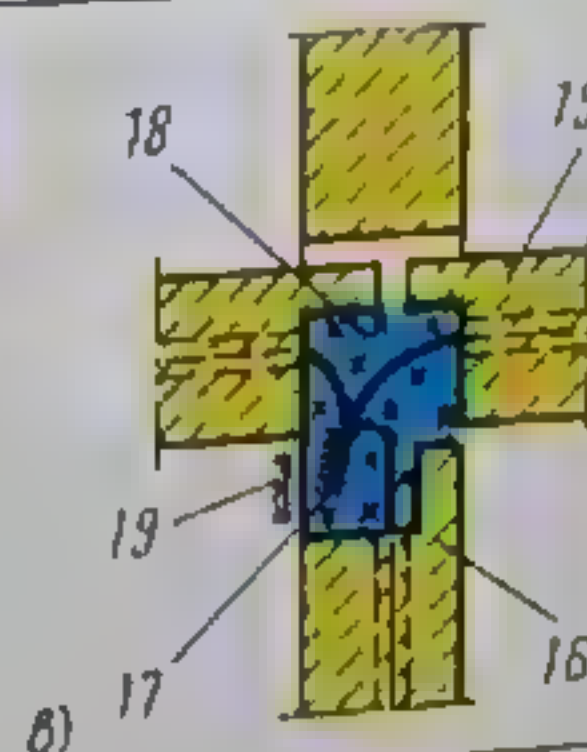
Как выполняют электропроводку в домах, собираемых из железобетонных плит
